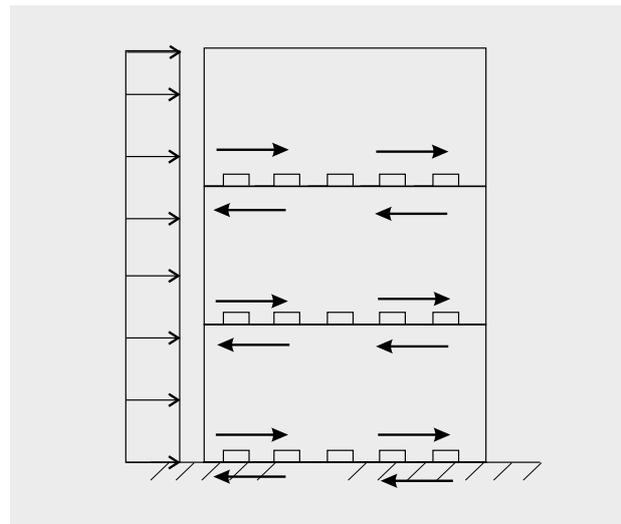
Aussteifungswand mit verzahnter Horizontalfuge
